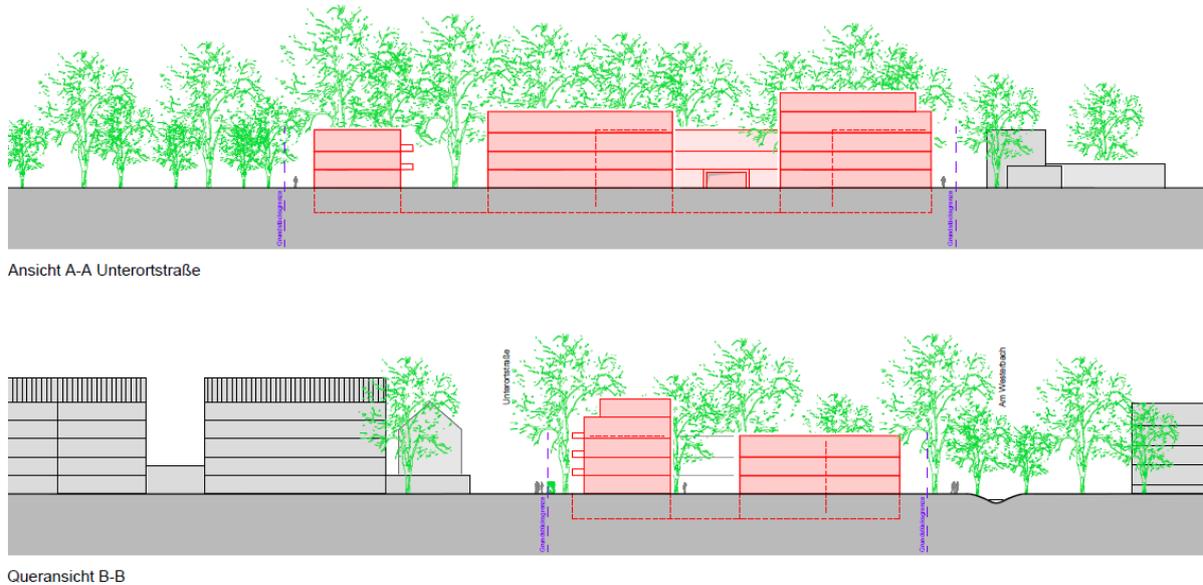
Schnitte der geplanten Wohngebäude – Quelle: Architekten Theiss
